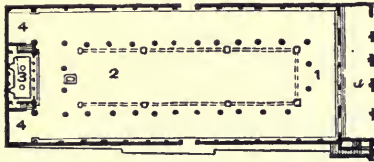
Grundriß der Basilika. a Vorhalle.
